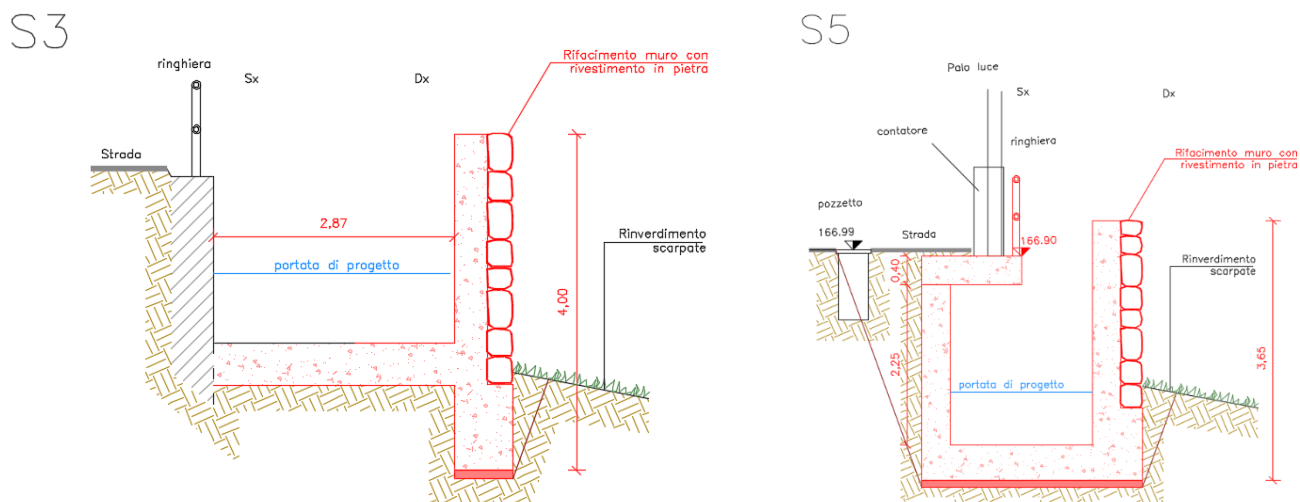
planimetria e sezioni di progetto di parte degli interventi nella zona A
